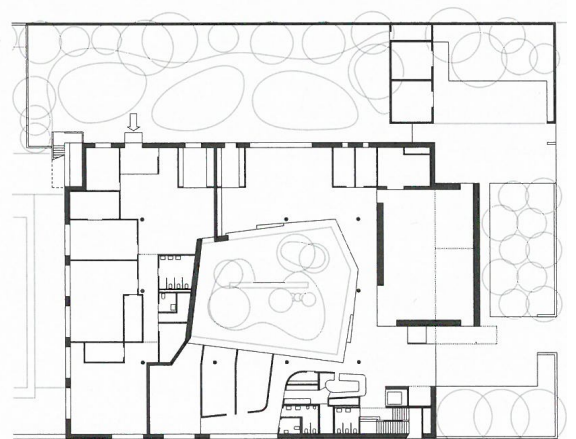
Grundriss 1. OG ©Paul Katzberger
